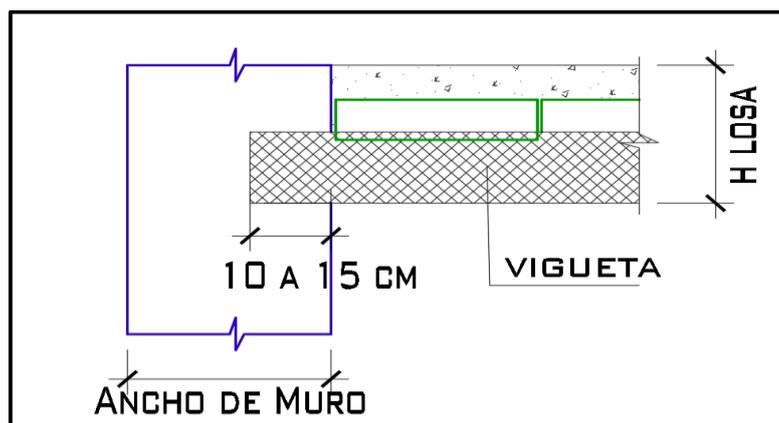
Detalle de ingreso de vigueta a placa extremo discontinuo.
